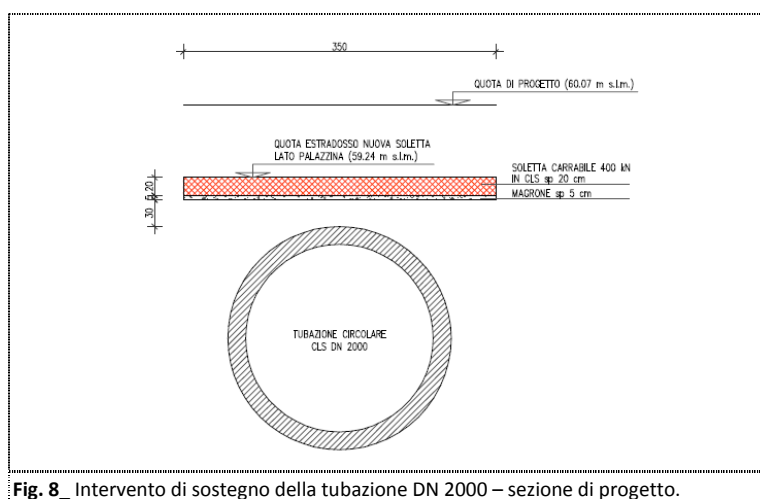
Intervento di sostegno della tubazione DN 2000 – sezione di progetto.
